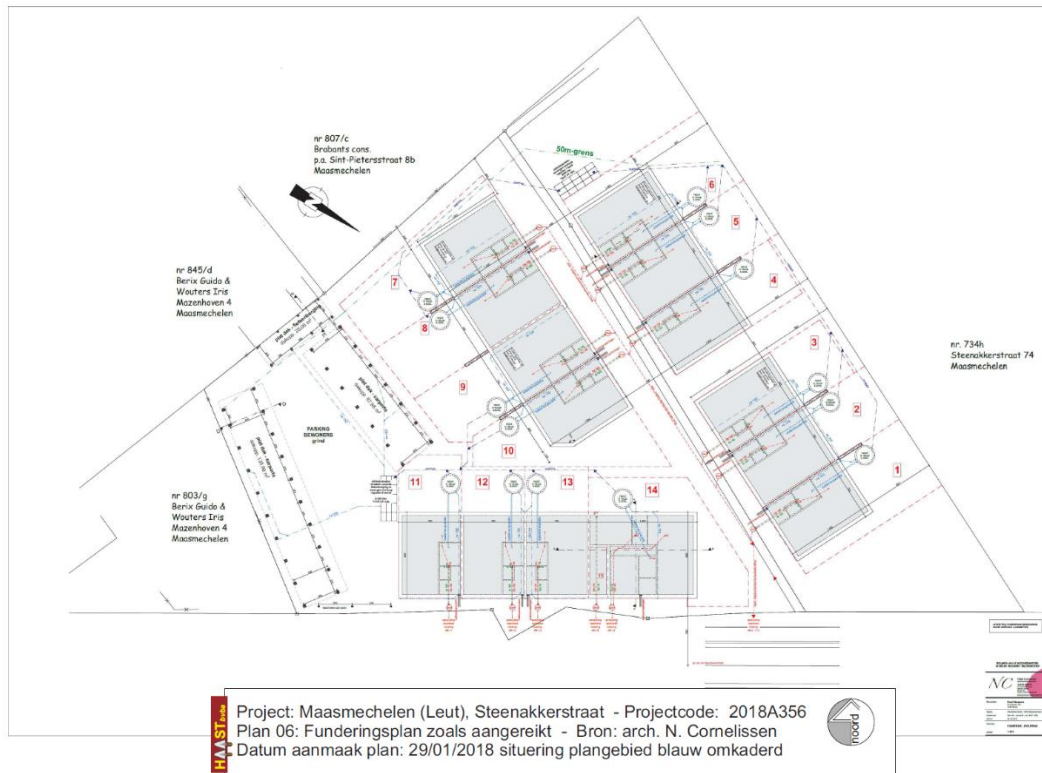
funderingsplan zoals aangereikt door het architectenbureau © architect N. Cornelissen
